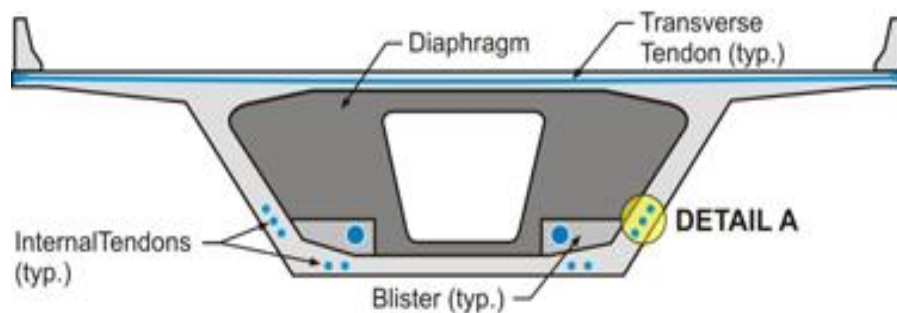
Sección transversal típica de una dovela de un puente viga-cajón.
